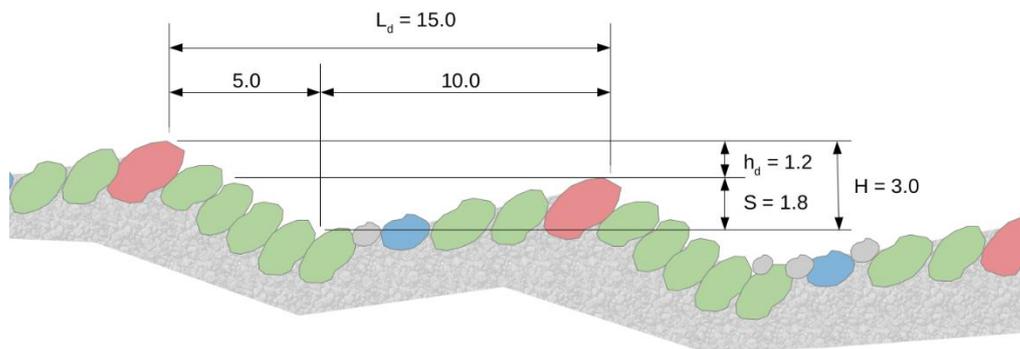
Definitive Abmessung der Stufen-Becken-Abfolge für die Ausführung.
